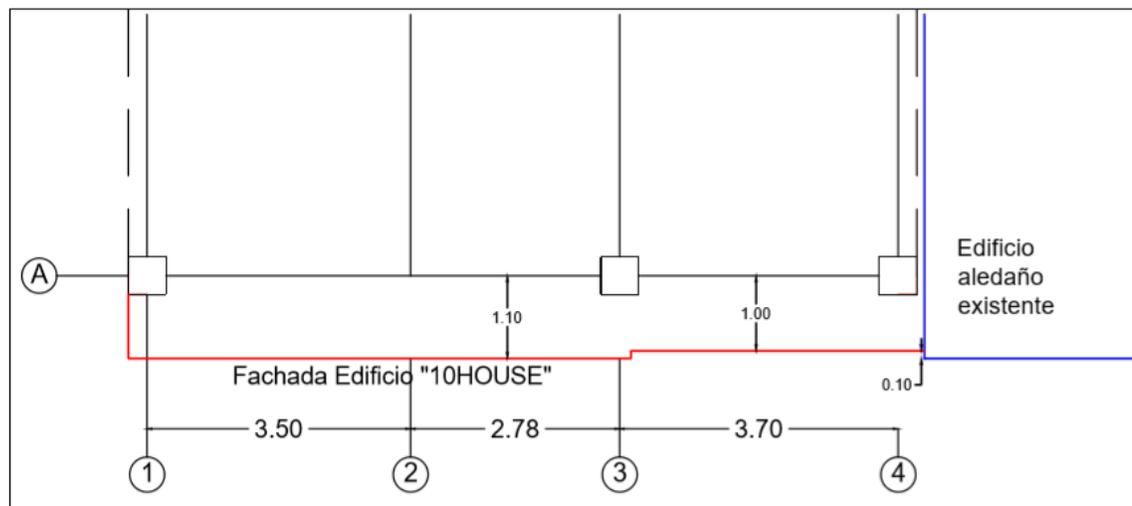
Detalle de fachada para el edificio 10HOUSE.
